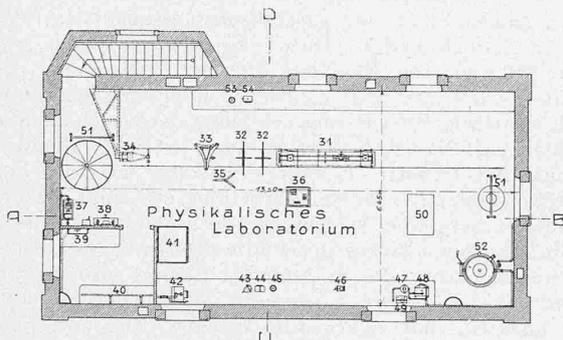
u. 3. Grundrisse vom Erdgeschoss und Obergeschoss. — 1 : 200. — Abb. 1. Grundriss vom Untergeschoss; Abb. 4. Schnitt A-B.
